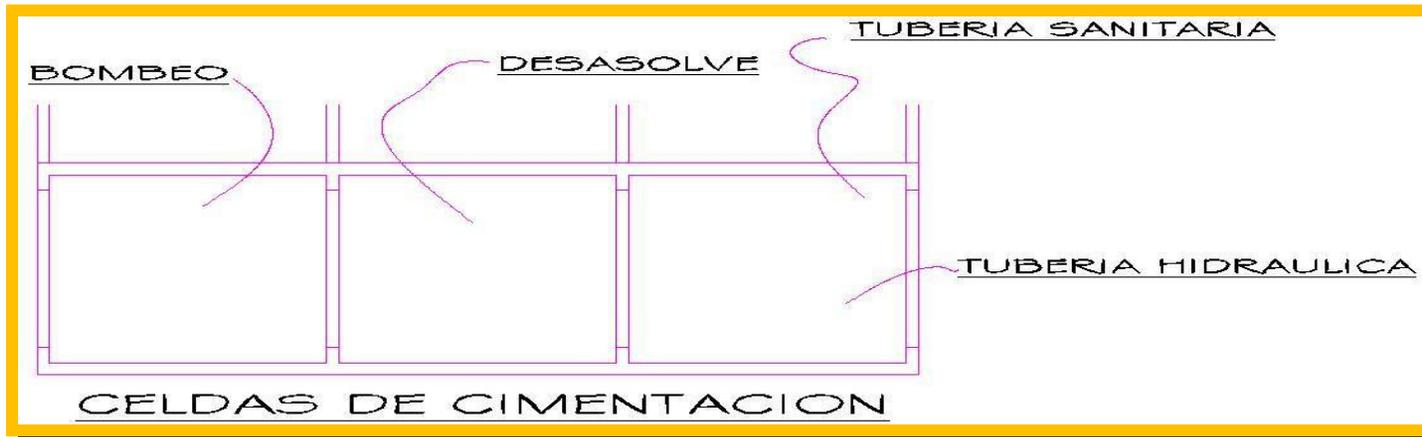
Proyecto de desazolve de celdas de cimentación
